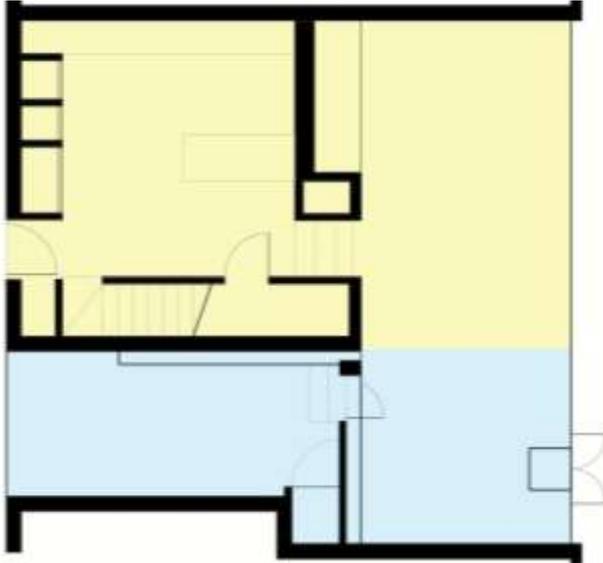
Planta de la vivienda Murray Mews. Azul: zona privada; Amarillo: zona de día.
